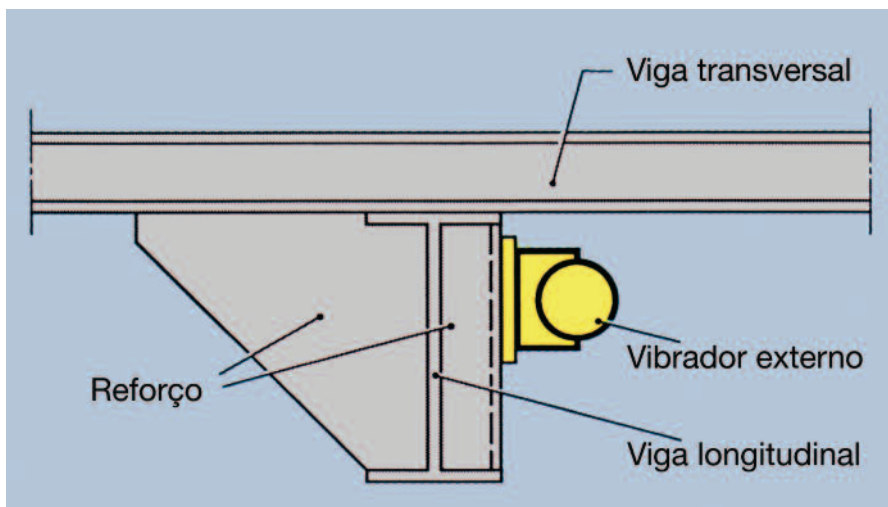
Ajuste de vibrador com reforço estrutural na viga longitudinal da mesa vibratória de grande formato
